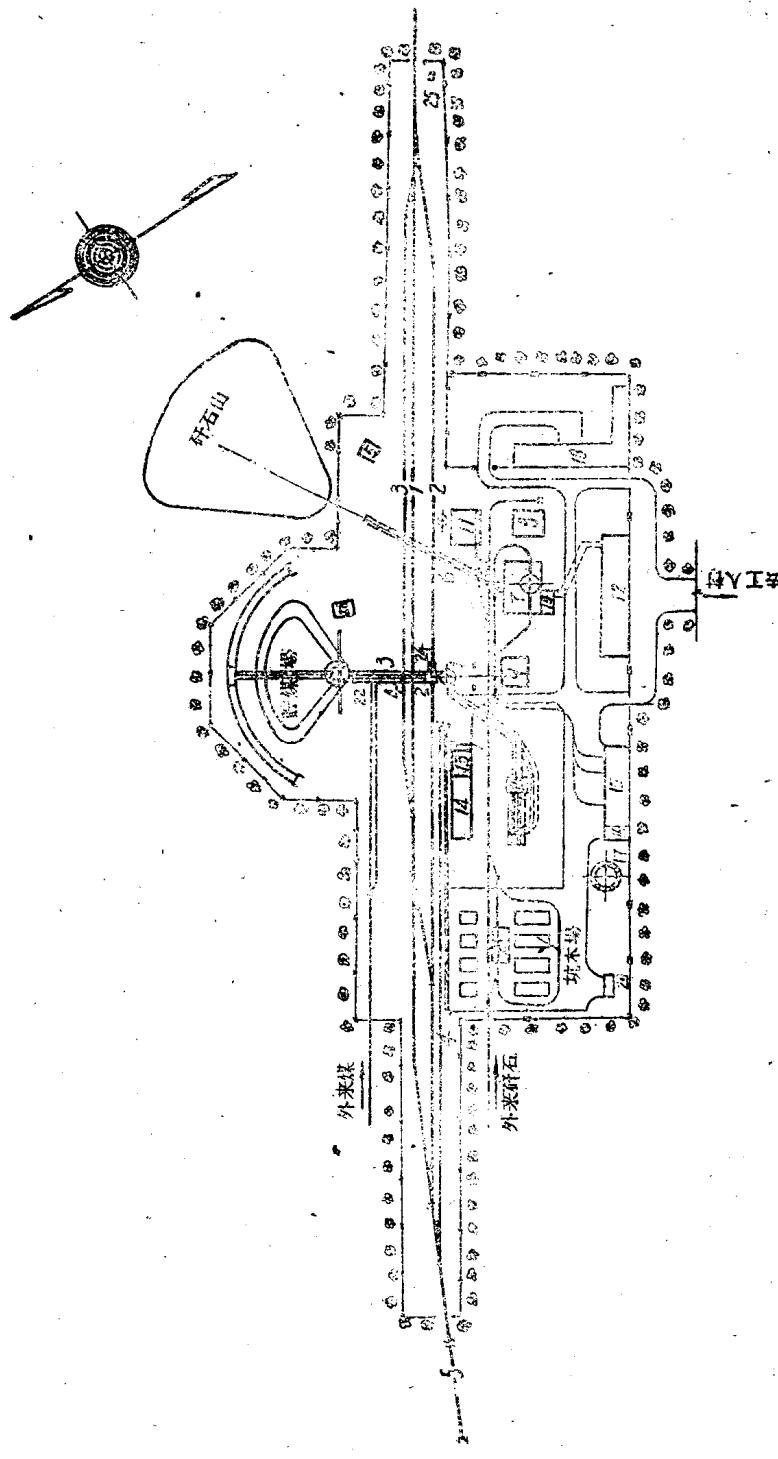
年产60万吨矿井(竖井)工业广场总平面图
